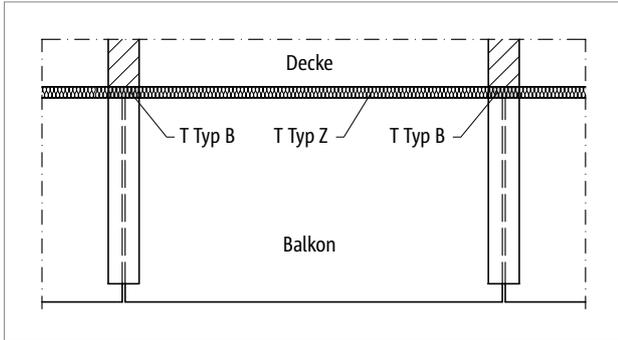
Schöck Isokorb® T Typ B: Balkonkonstruktion mit frei ausragenden Unterzügen (Fertigteilbalkon)
